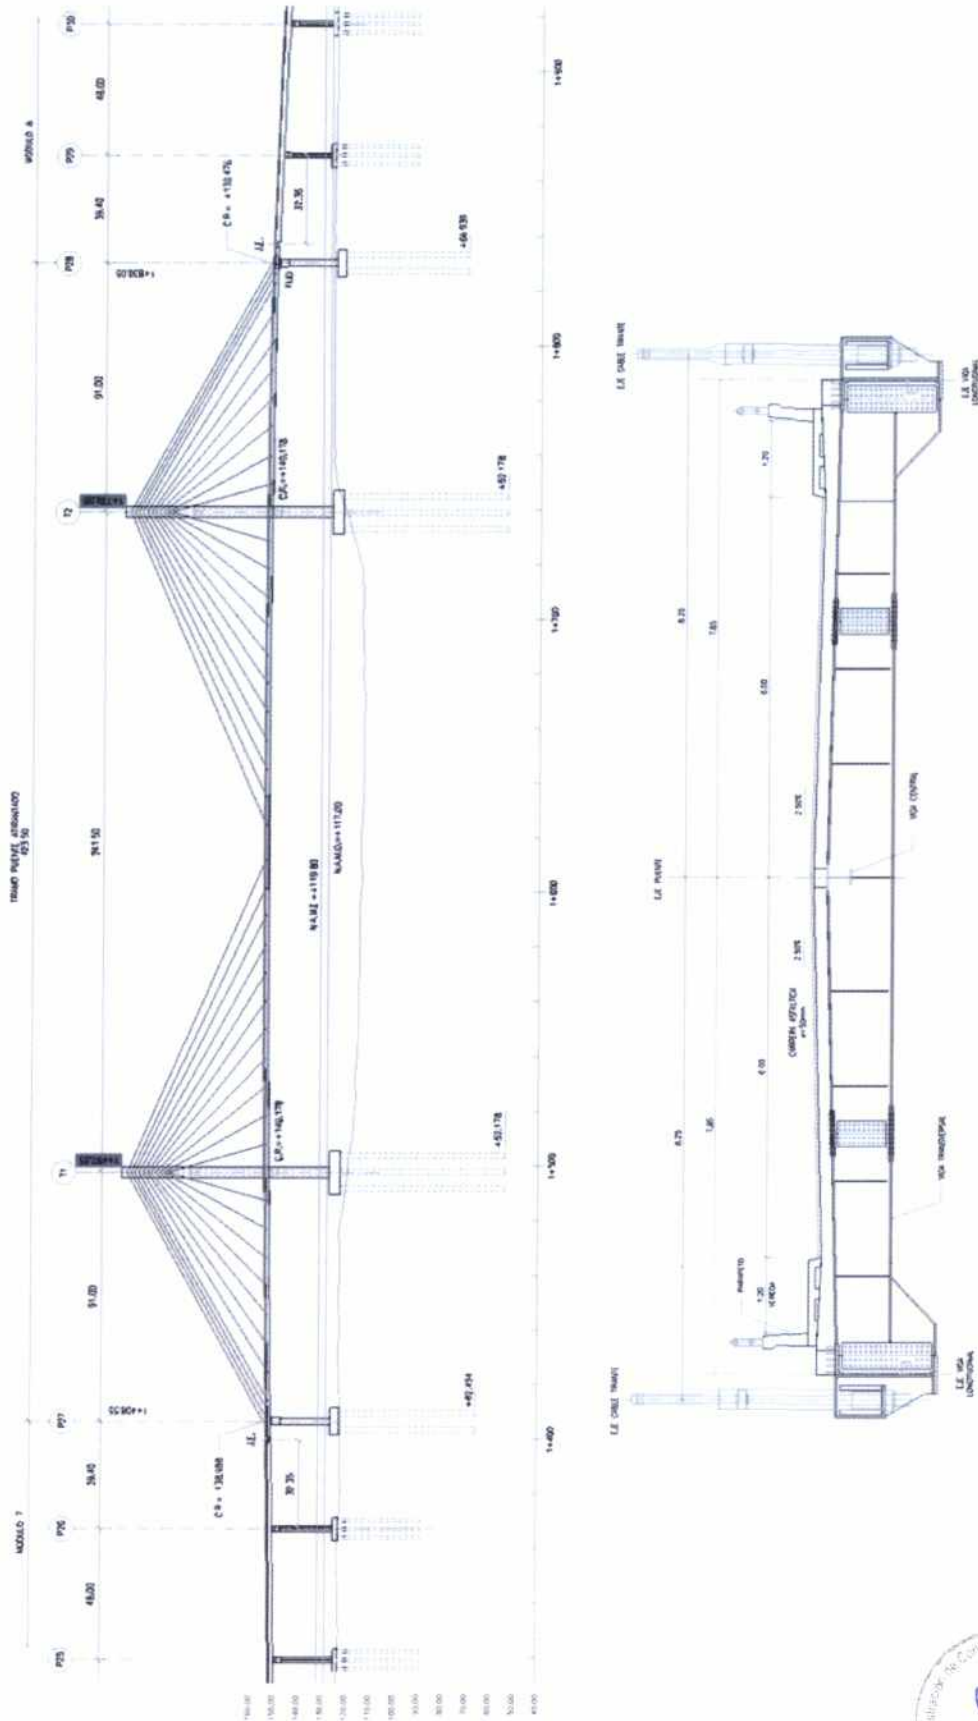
Puente NANAY, Atirantado, Elevación y sección transversal
